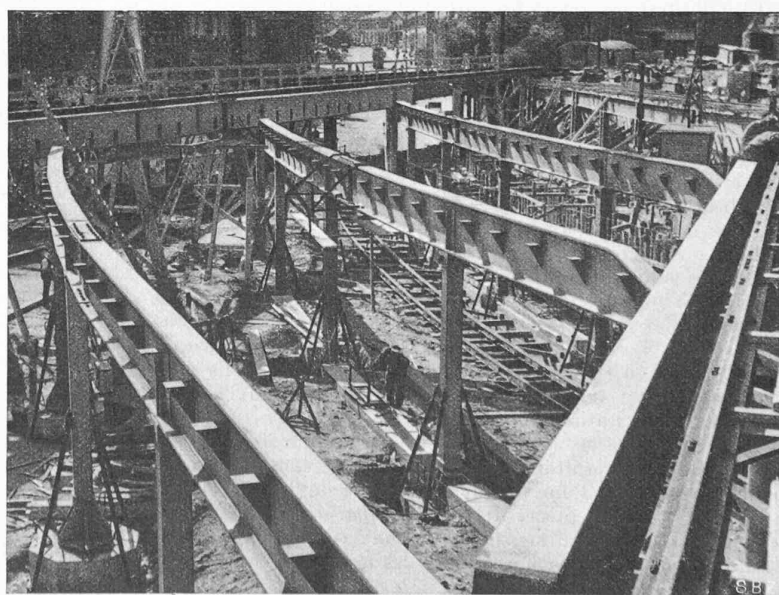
Montage de la construction métallique du lot 5 b. (Passage inférieur de la Neubrückstrasse.)
